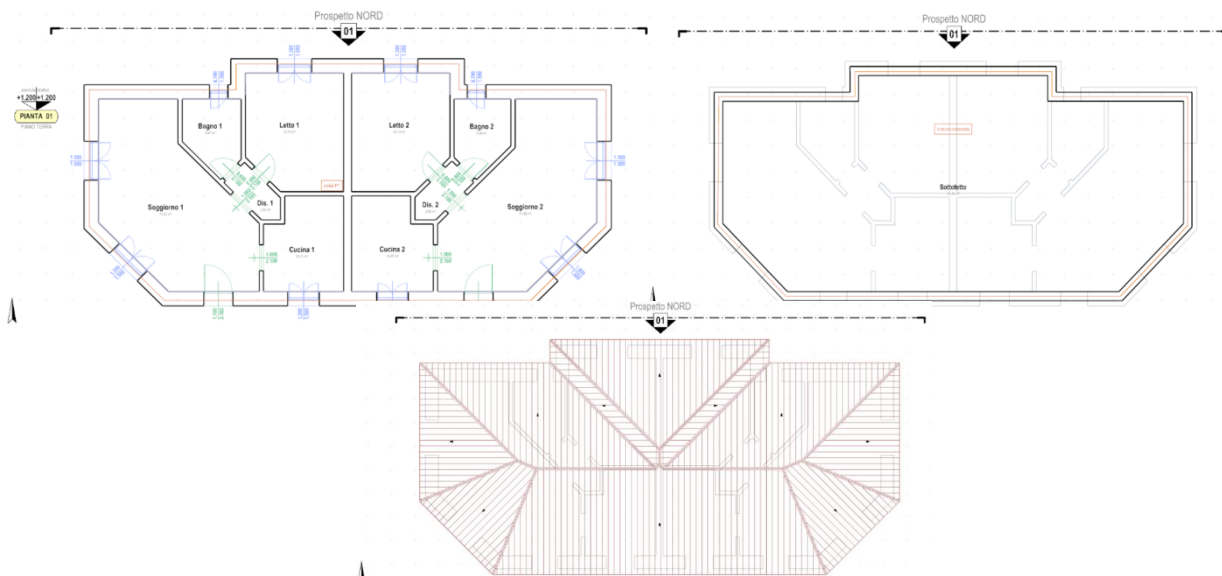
Piante del piano terra, sottotetto e tetto del modello.
